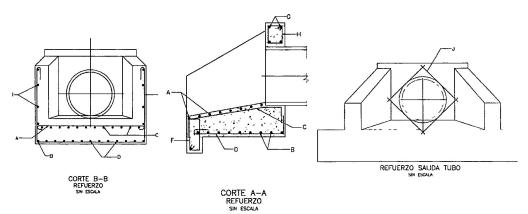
Detalle de refuerzo de la estructura de cabezal en concreto para alcantarilla de drenaje<sup>8</sup>. El acero de refuerzo de la estructura de cabezal en concreto para alcantarilla de drenaje, mostrado en los anteriores detalles, está dado por el siguiente despiece longitudinal y transversal:
